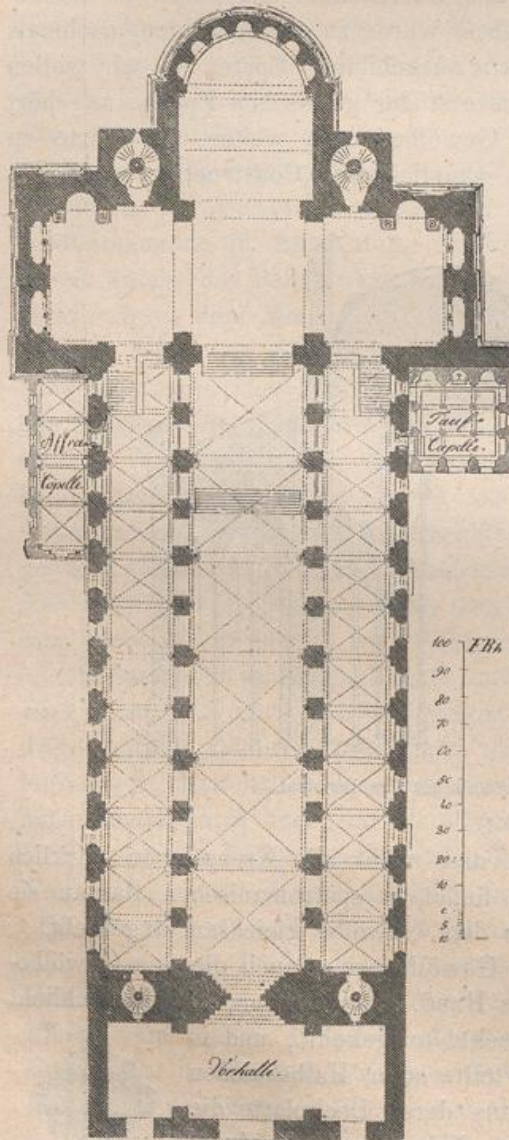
Dom zu Speyer, Grundriss.
